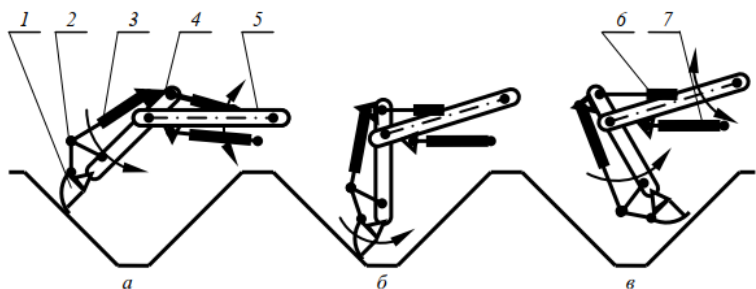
Схема работы экскаватора с уширенным поворотным (циркульным) ковшом: а – очистка дальнего откоса; б – очистка дна; в – очистка ближнего откоса; 1 – ковш; 2 – рычажная система; 3 – гидроцилиндр рукояти; 4 – рукоять; 5 – стрела; 6 – фреза; 7 – гидроцилиндр стрелы.
